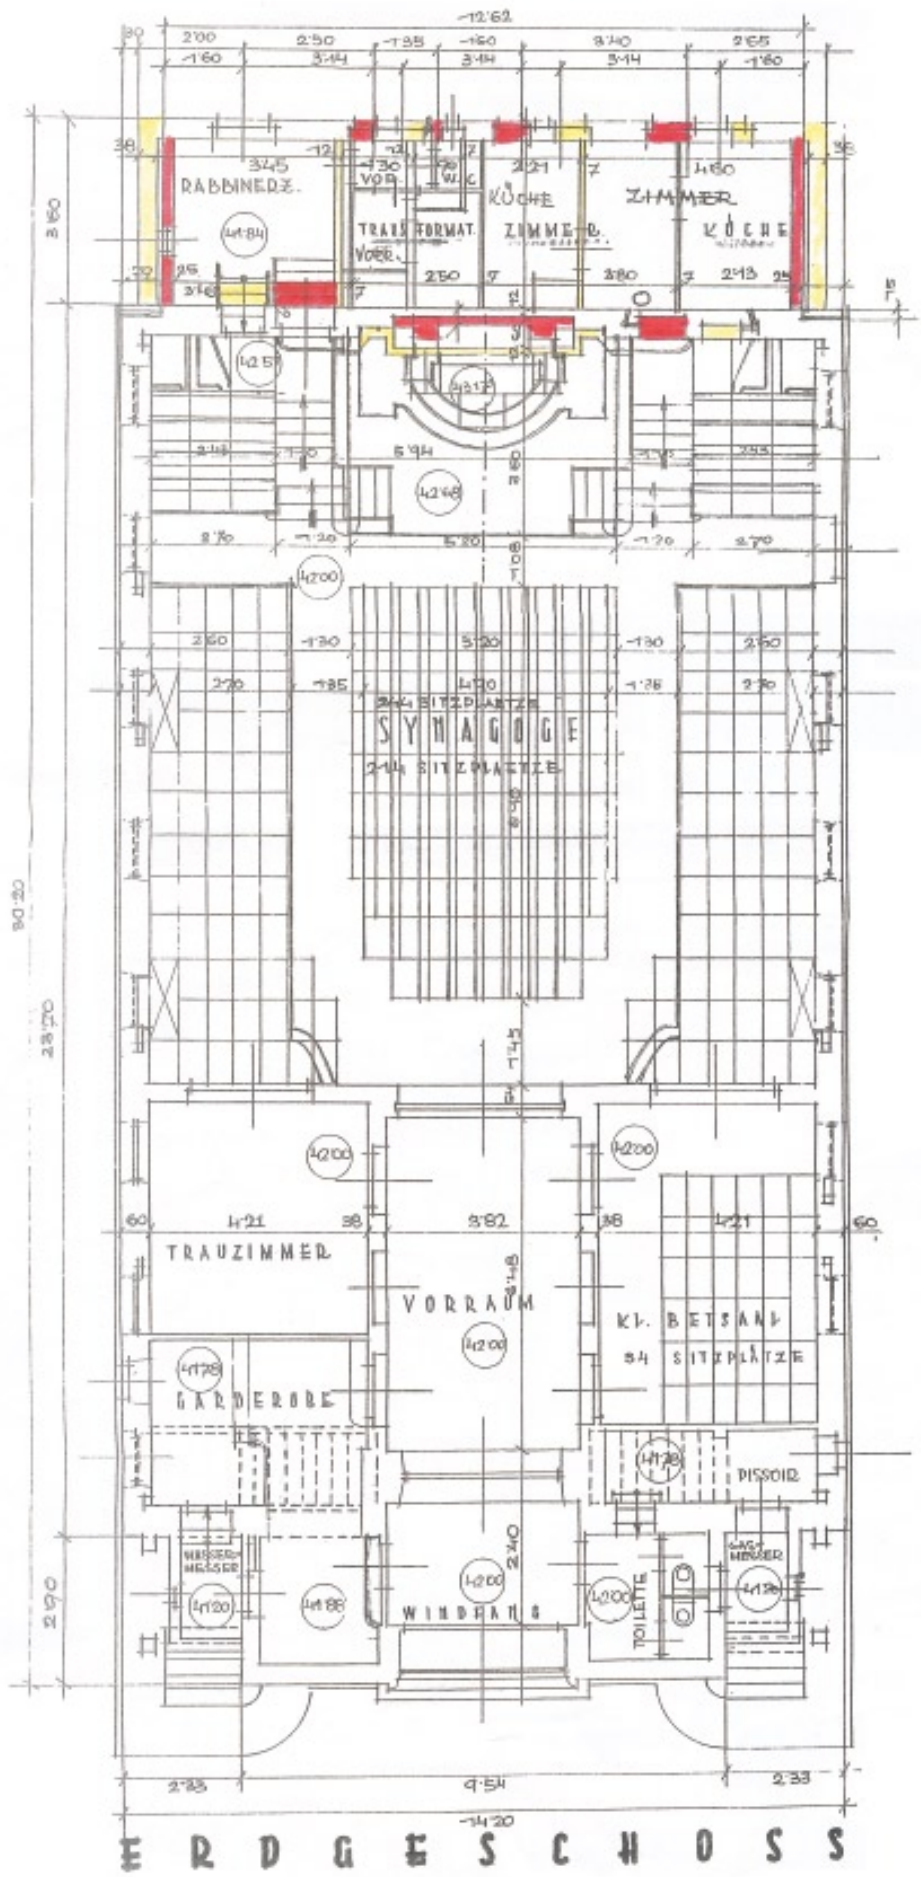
Grundriss Oktober 1928, Auswechslungsplan
